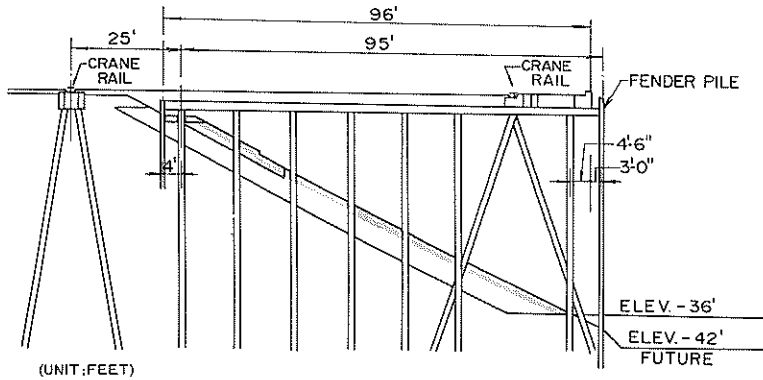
APL ターミナルの岸壁 (バース60, 61) の標準断面図
